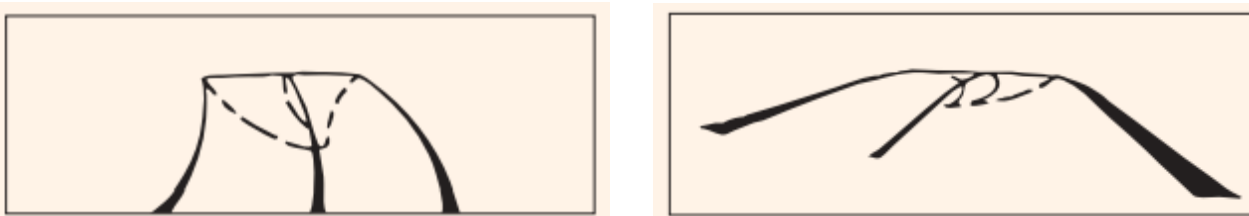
Situaciones a evitar en la coordinación planta alzado II
